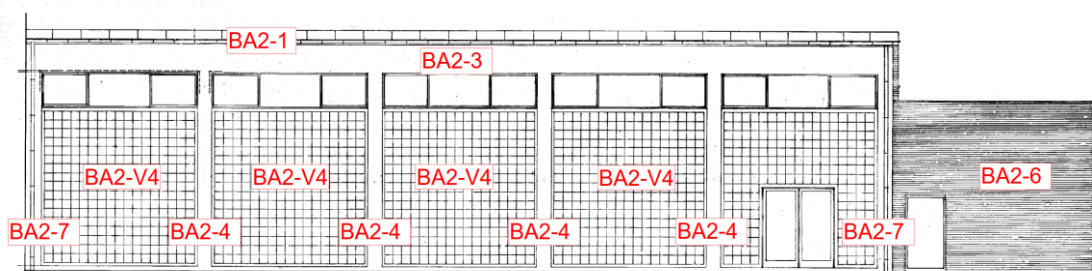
Rückbau – Prinzipdarstellung, Ansicht Turnhalle, Ausschnitt aus Anlage 8
